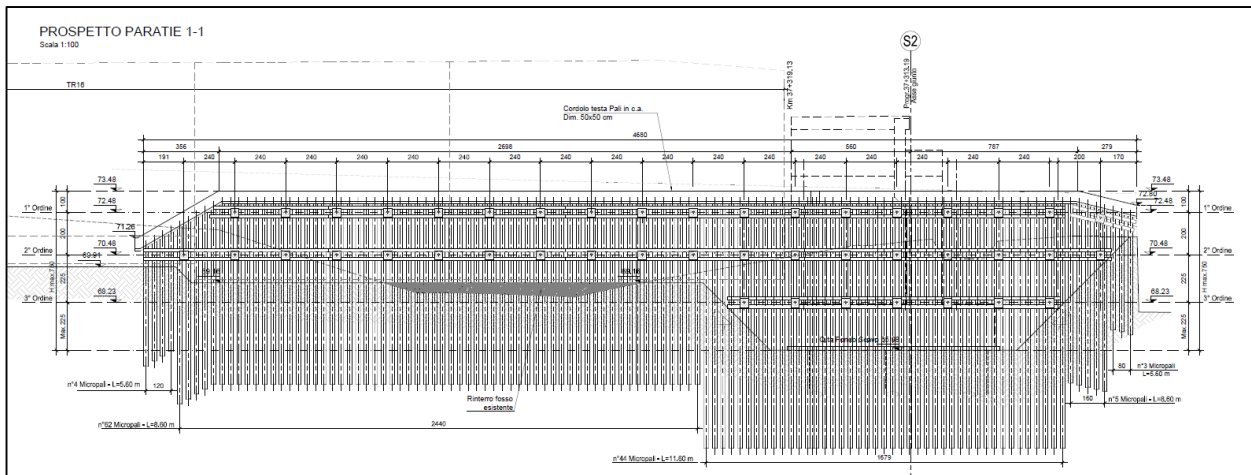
Sviluppo Longitudinale Paratia provvisoriale spalla S2
